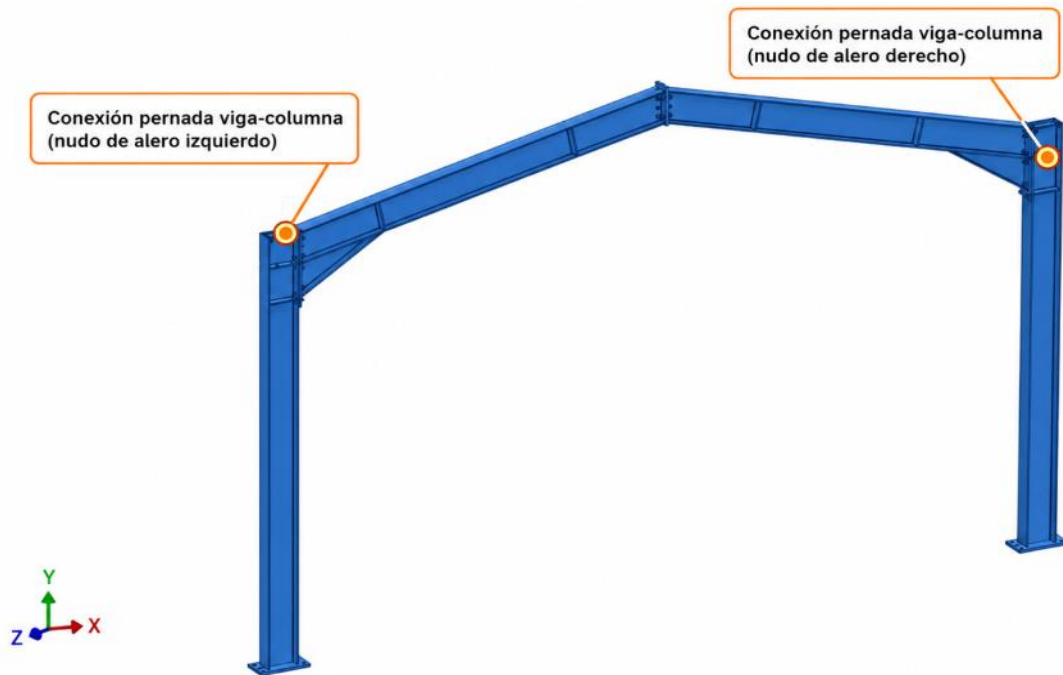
Pórtico metálico tipo portal y detalle de la conexión pernada viga-columna seleccionada para el análisis.
